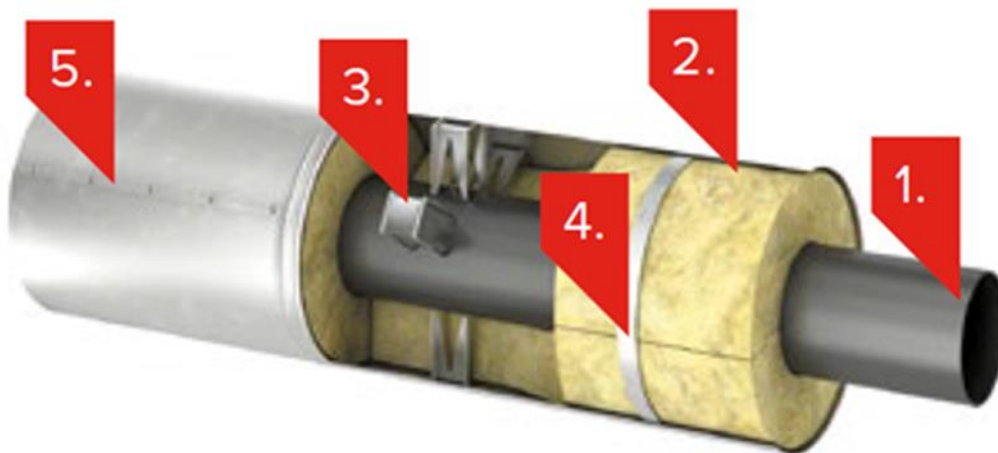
Індустріальна теплоізоляція трубопроводу:
